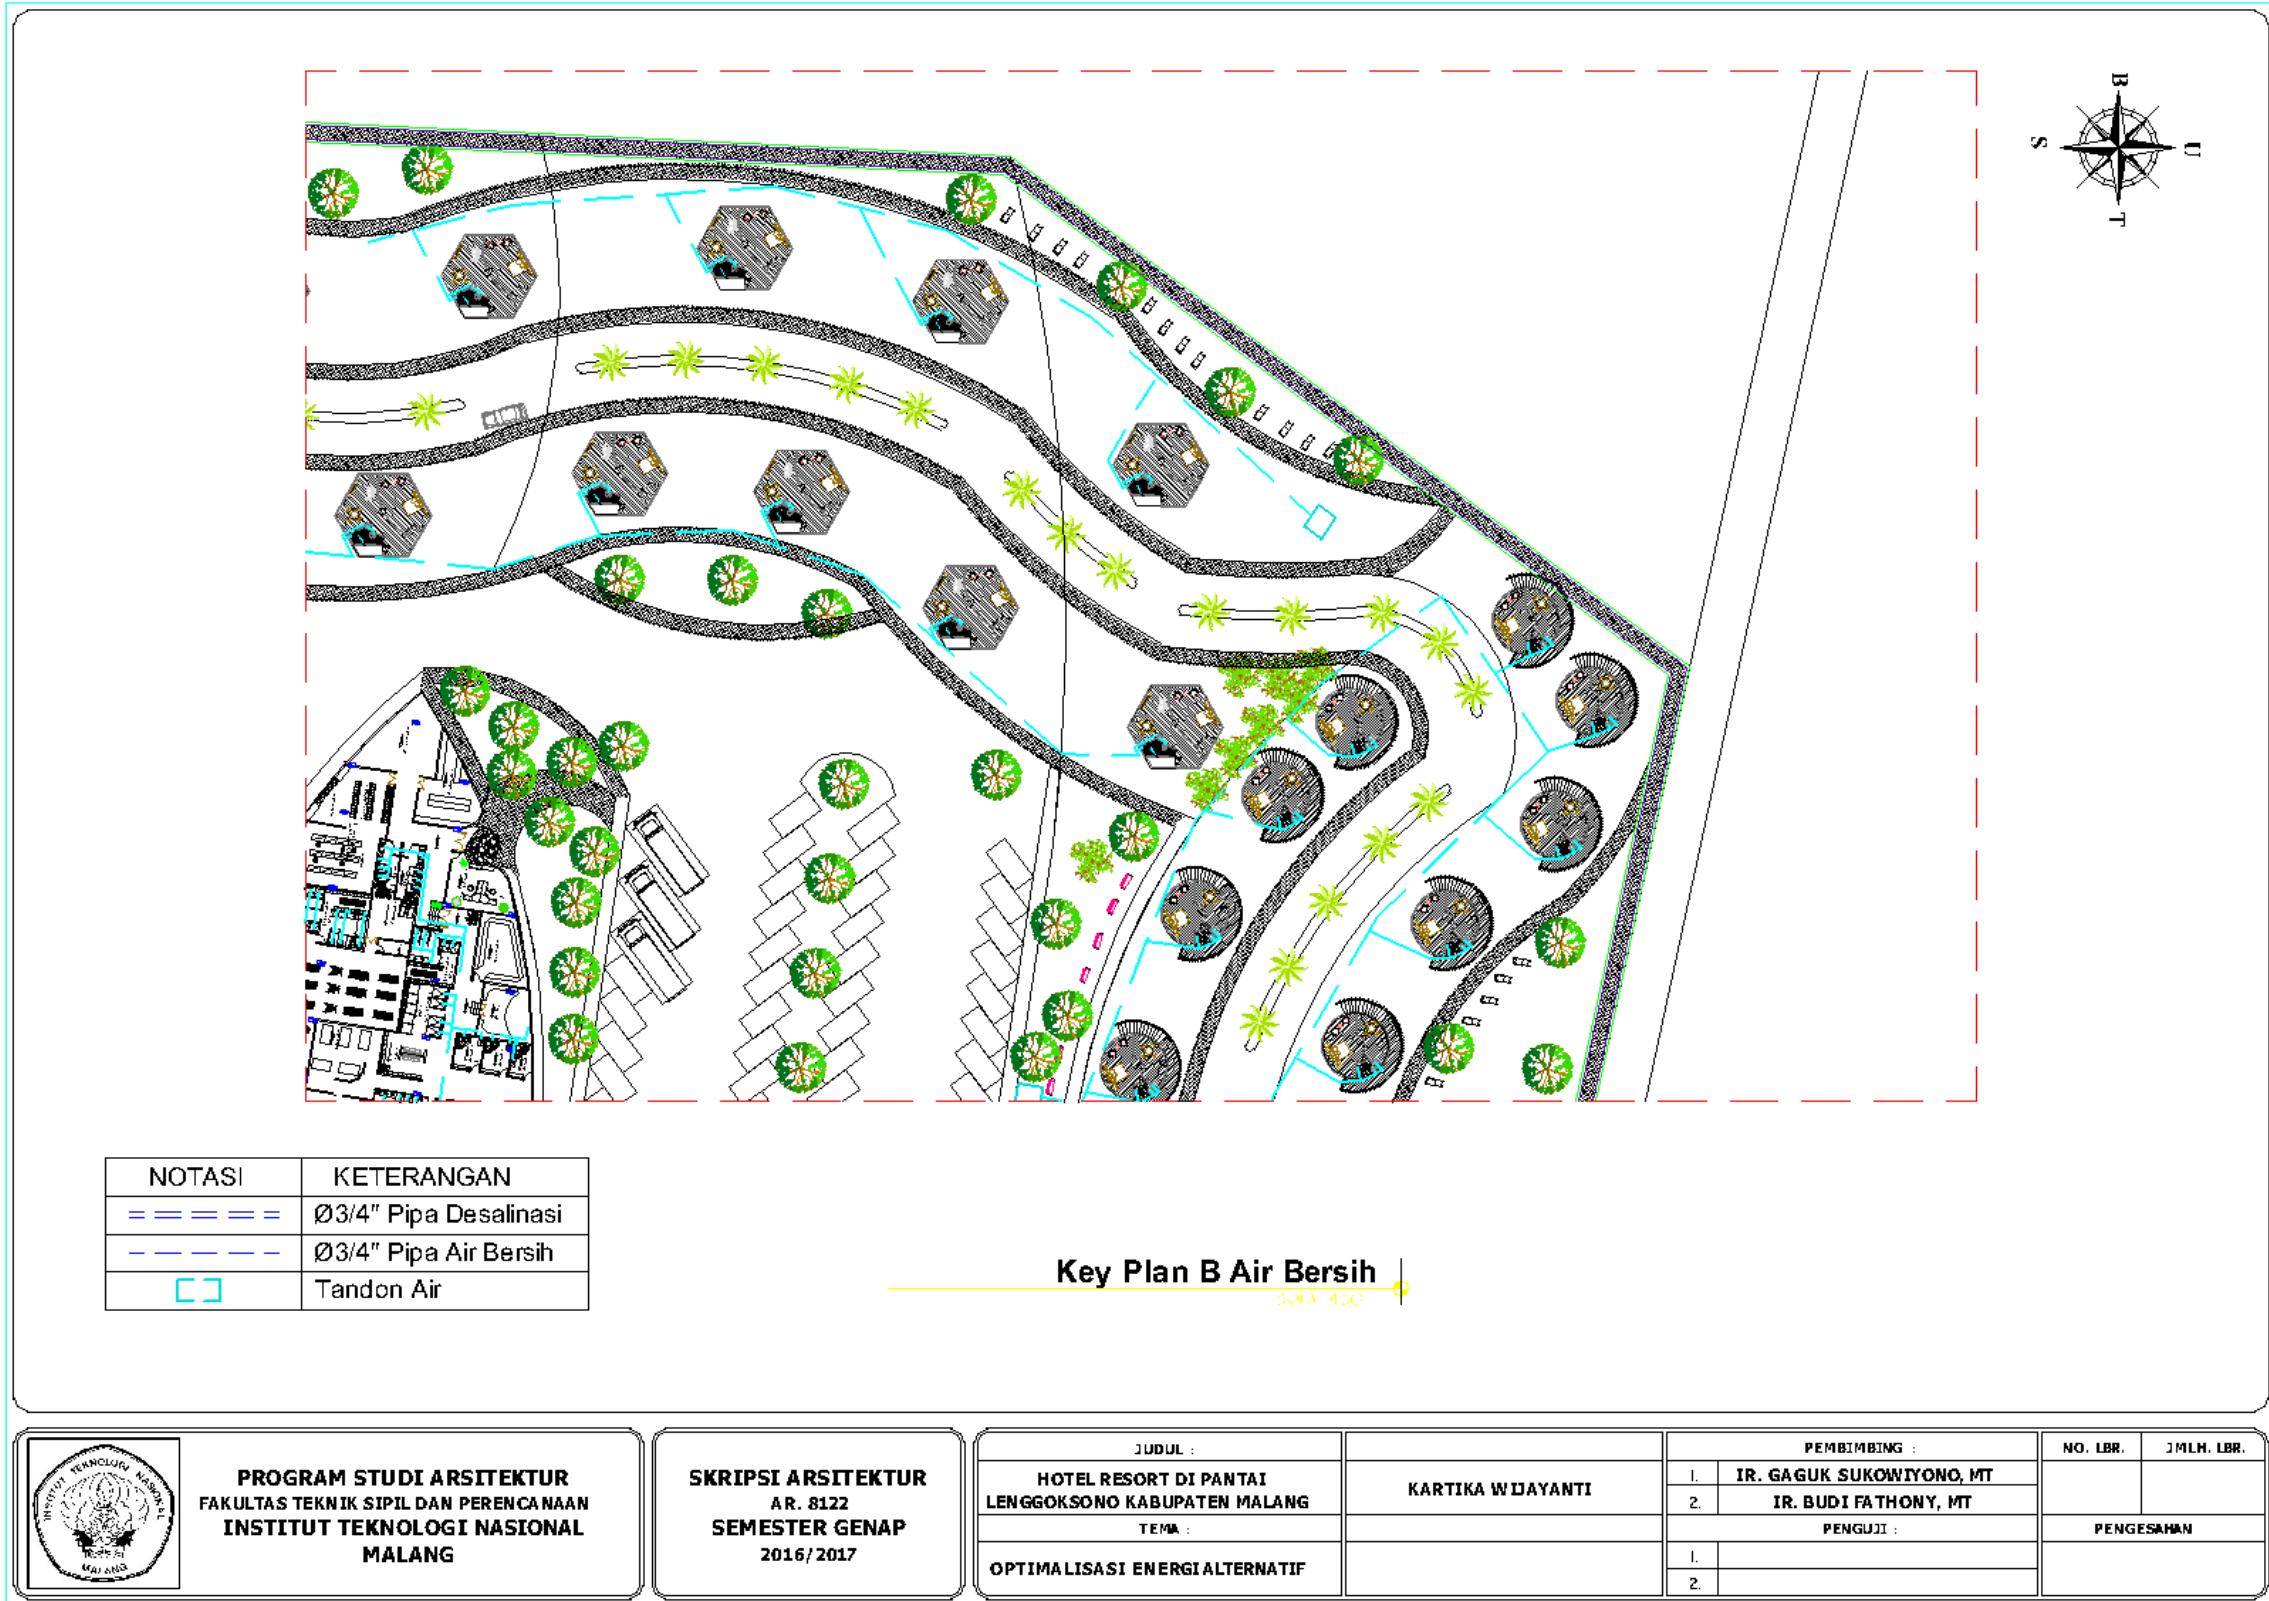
Gambar Sistem Instalasi Air Bersih (Sumber: DokumenPribadi)
